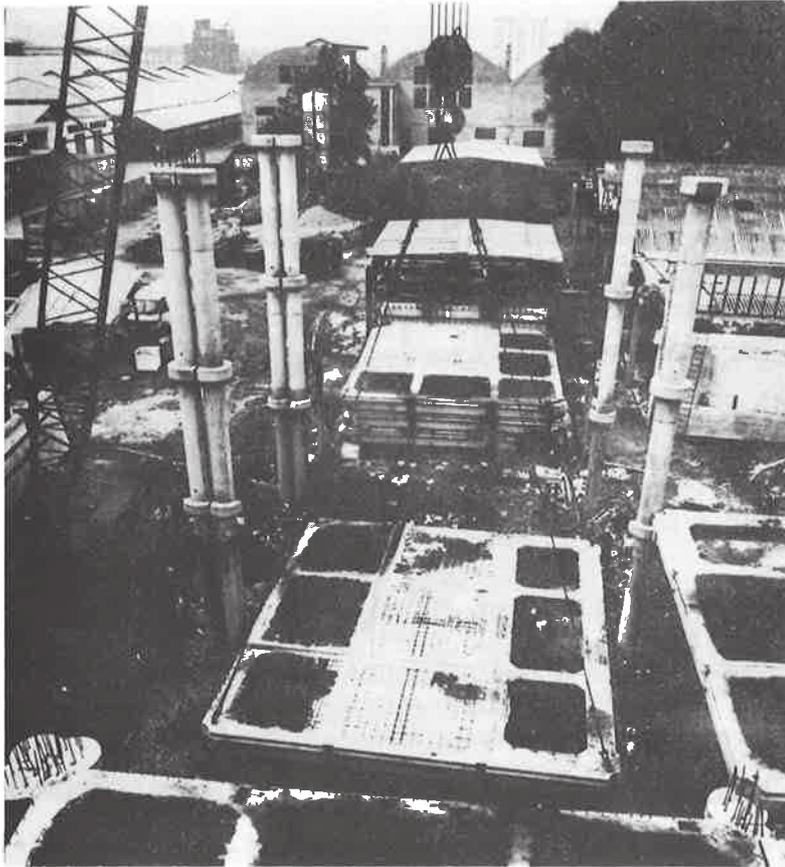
movimentazione piastre con cavalletto su binario - rif. IV
